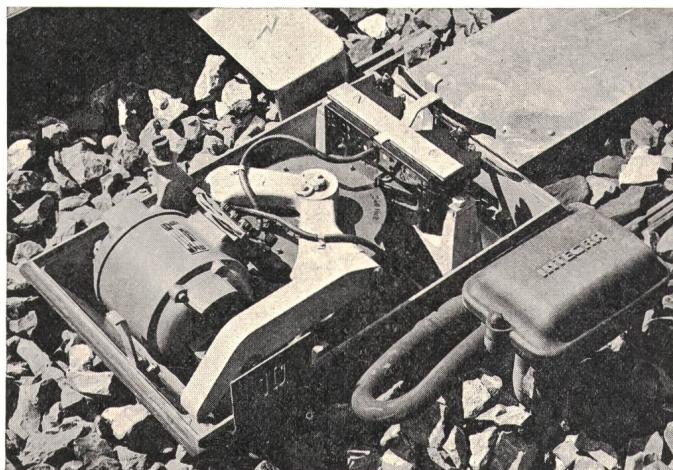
Elektrischer Weichenantrieb mit Drehstrommotor, einstellbarer Rutschkupplung und Endkontakten Gehäuse und Endkontakte offen
